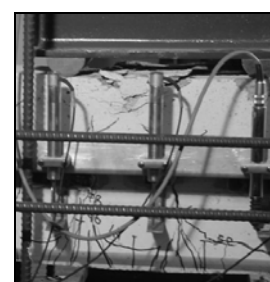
Pormenor da zona de rotura da viga A10_M.
